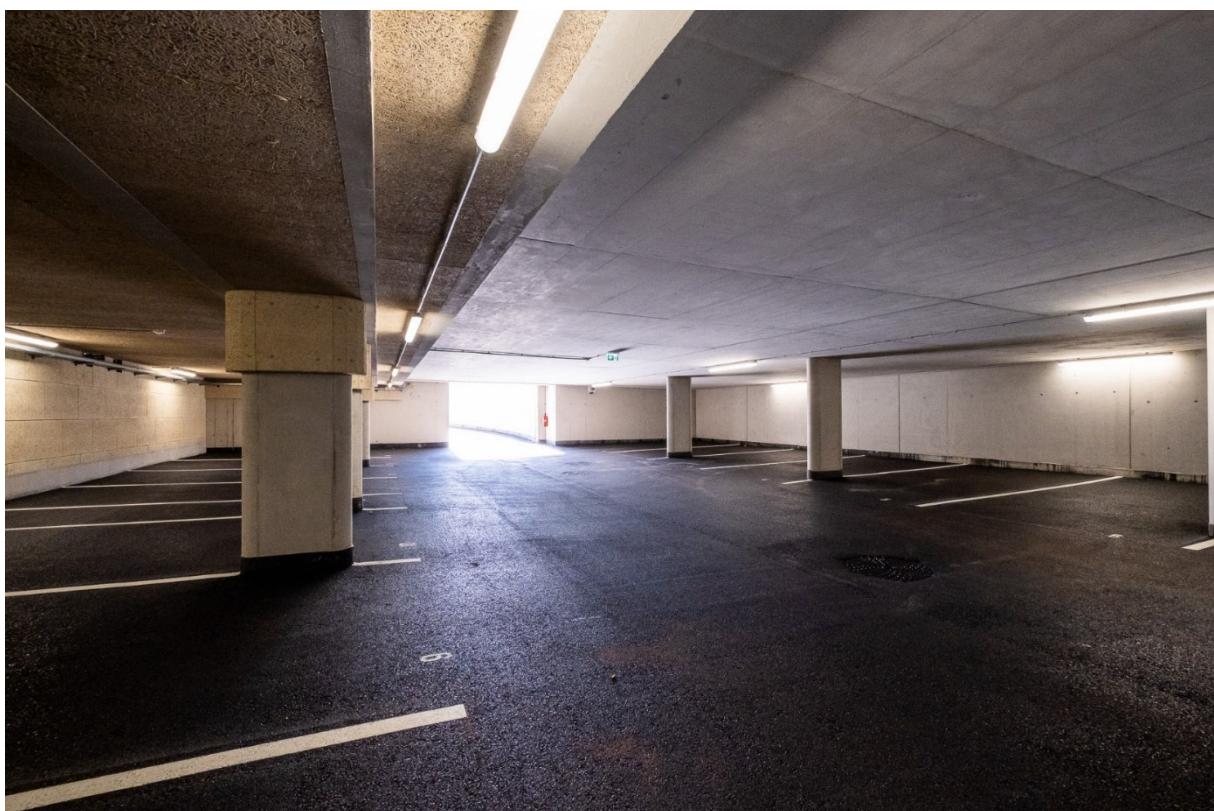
Abb. GHS Standardausstattung TG am Beispiel WA Achenkirch
